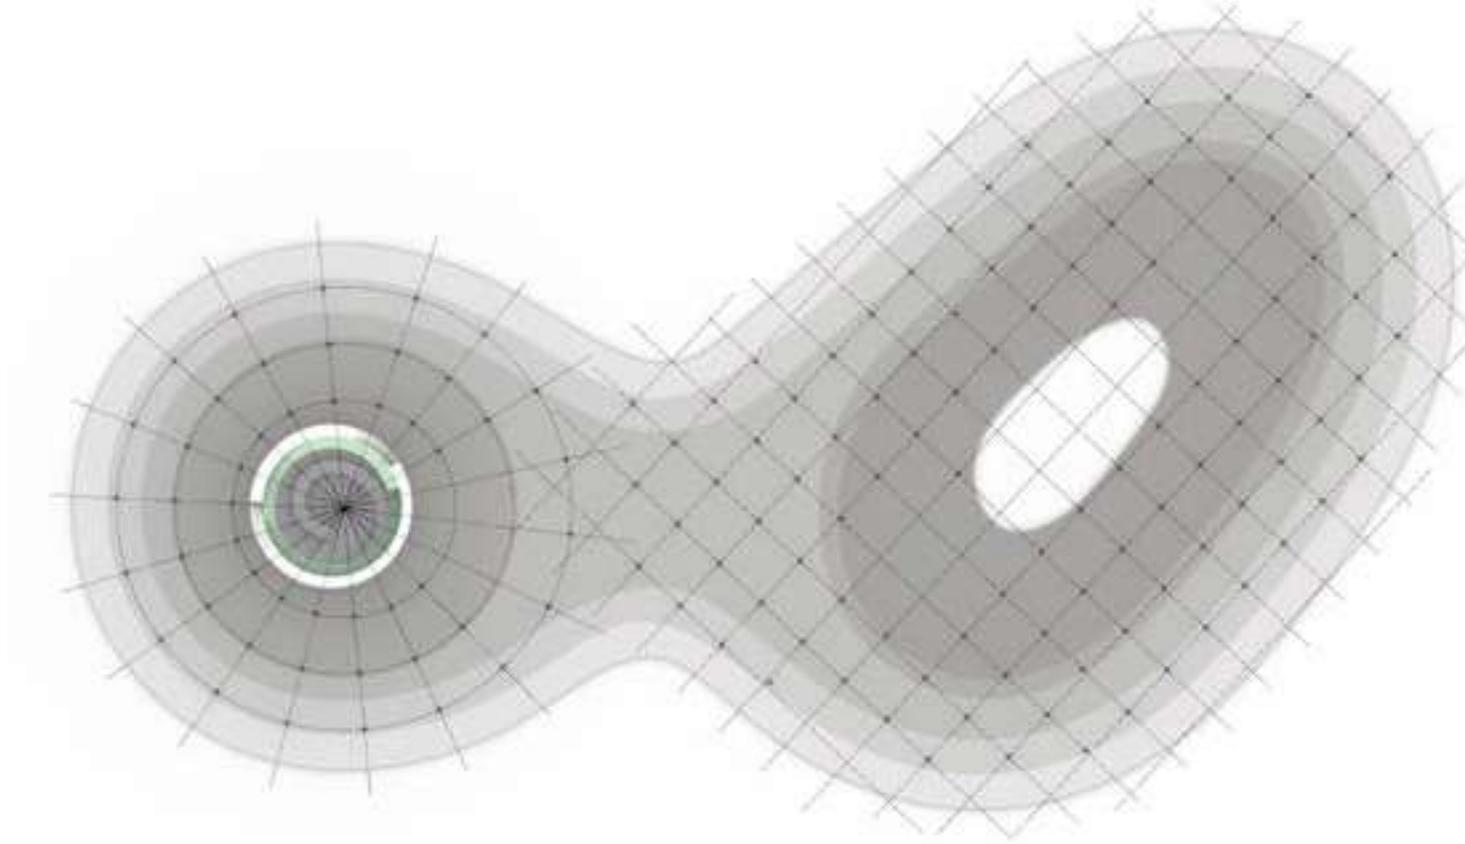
Grundriss - Achsenraster Tragwerkskonzept
